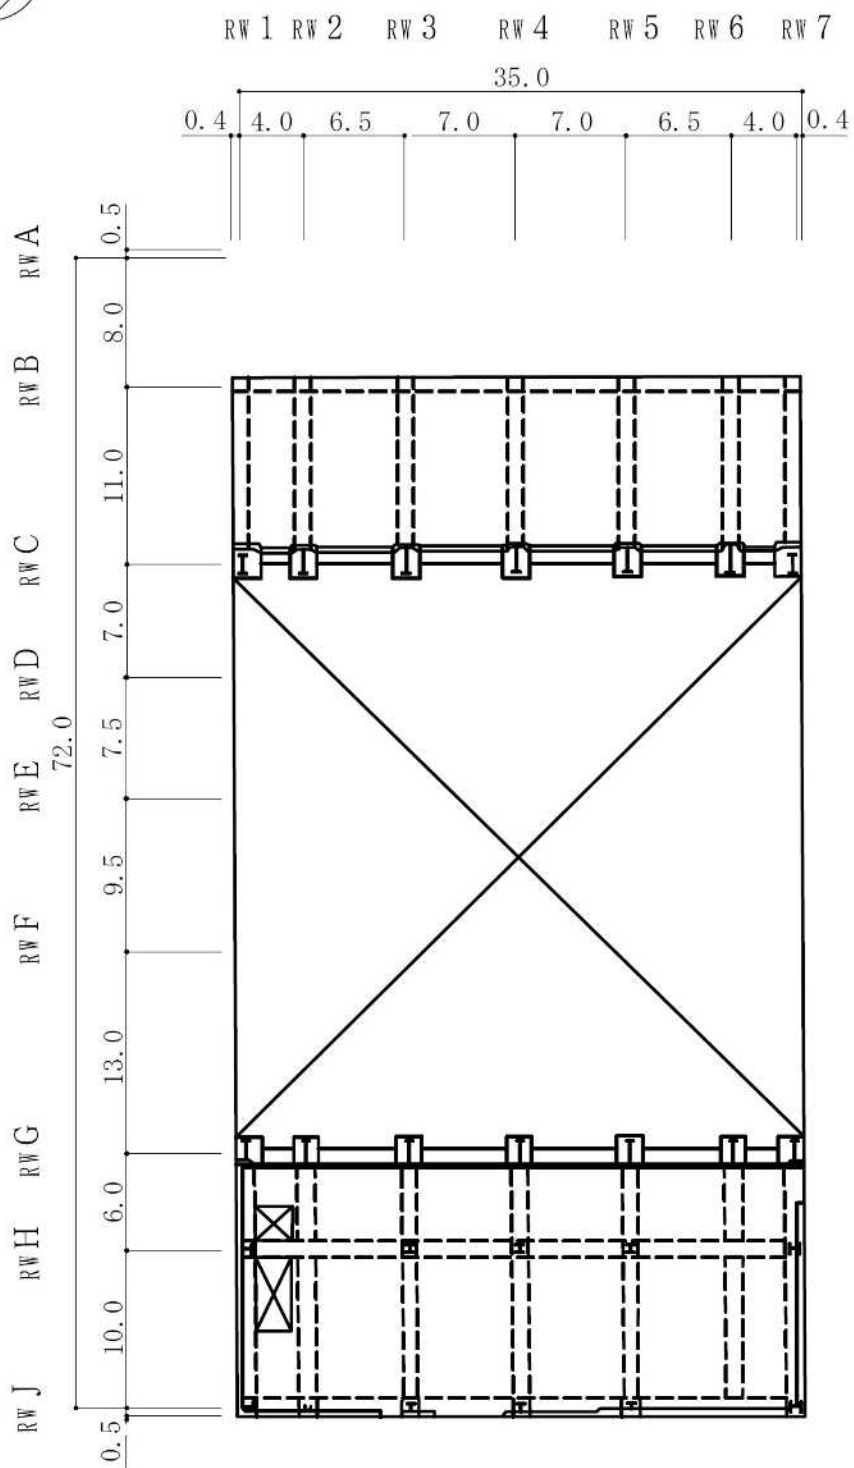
廃棄物処理建屋の概略平面図 (1F, T. M. S. L. 12.3m) (4/8)
